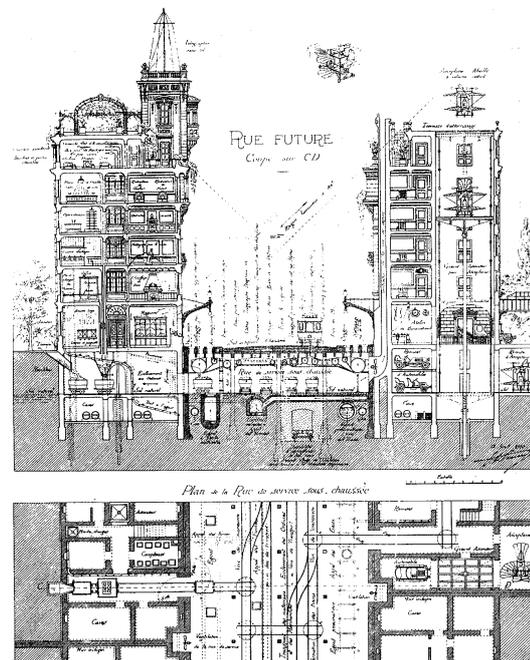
Rua em Múltiplos Pavimentos em 1911
